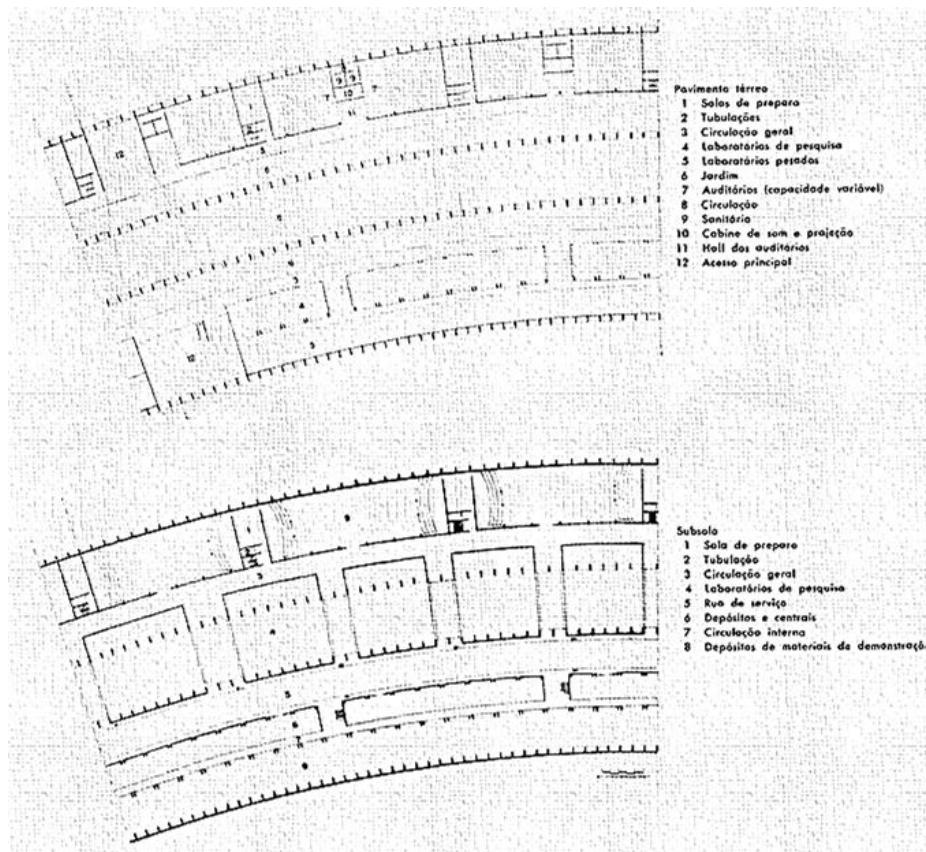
Pavimento Térreo e Subsolo do ICC.
